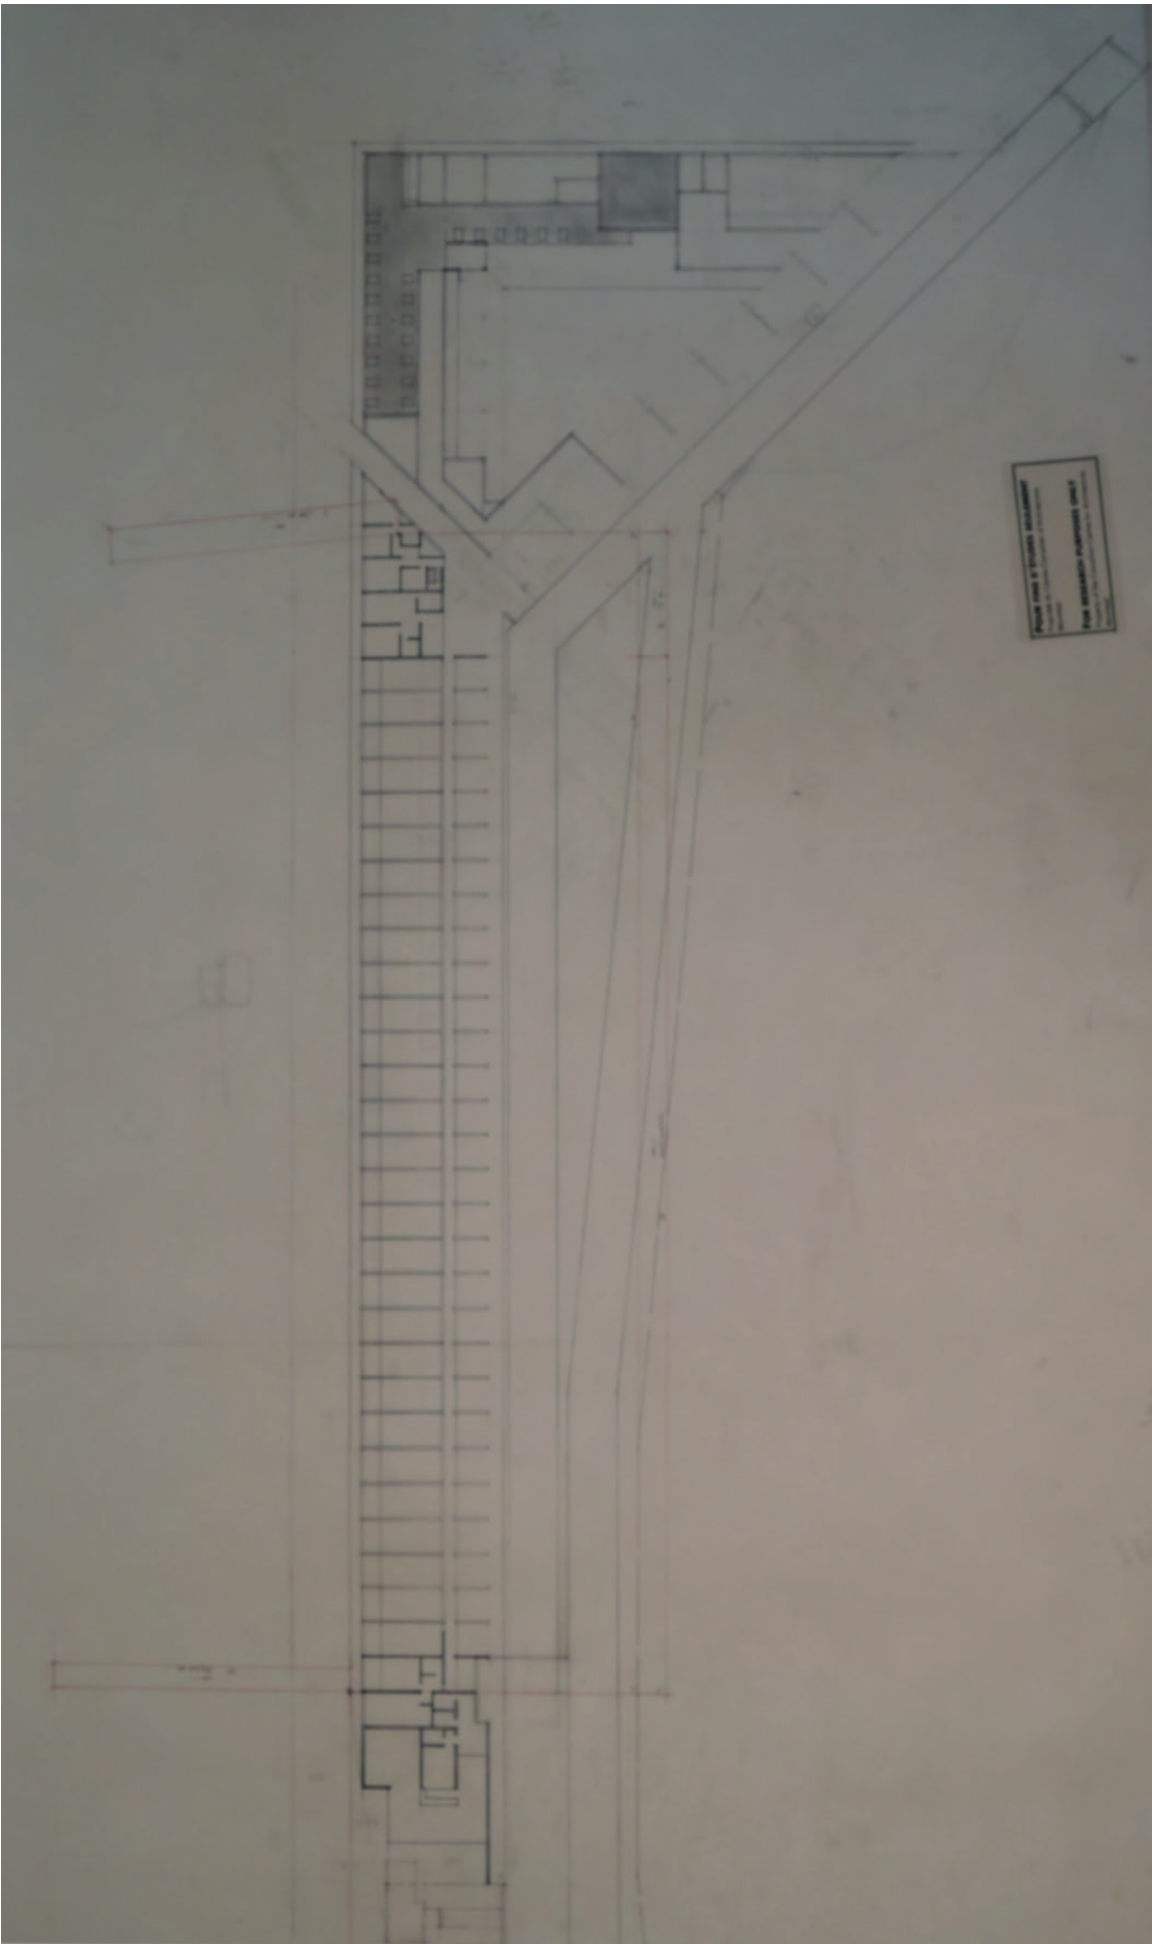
Planta do projeto do motel com o restaurante; CCA - Canadian Centre for Architecture.
